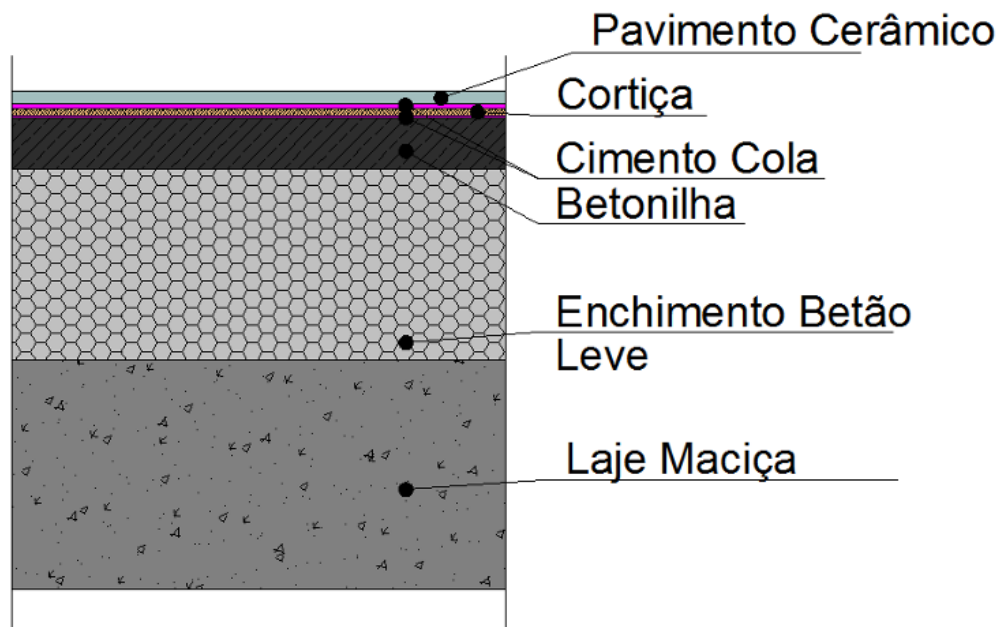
Pormenor de pavimento executados na torre do elevador
